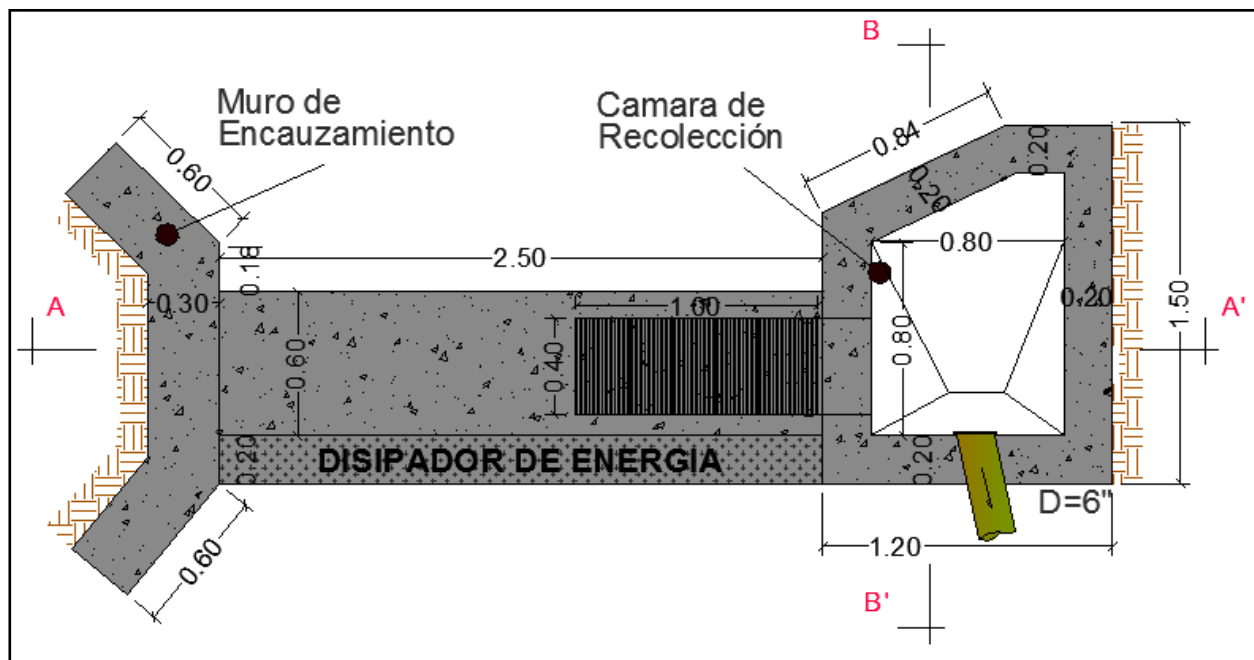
Plano en planta de la bocatoma existente. Fuente: Autores del proyecto.
